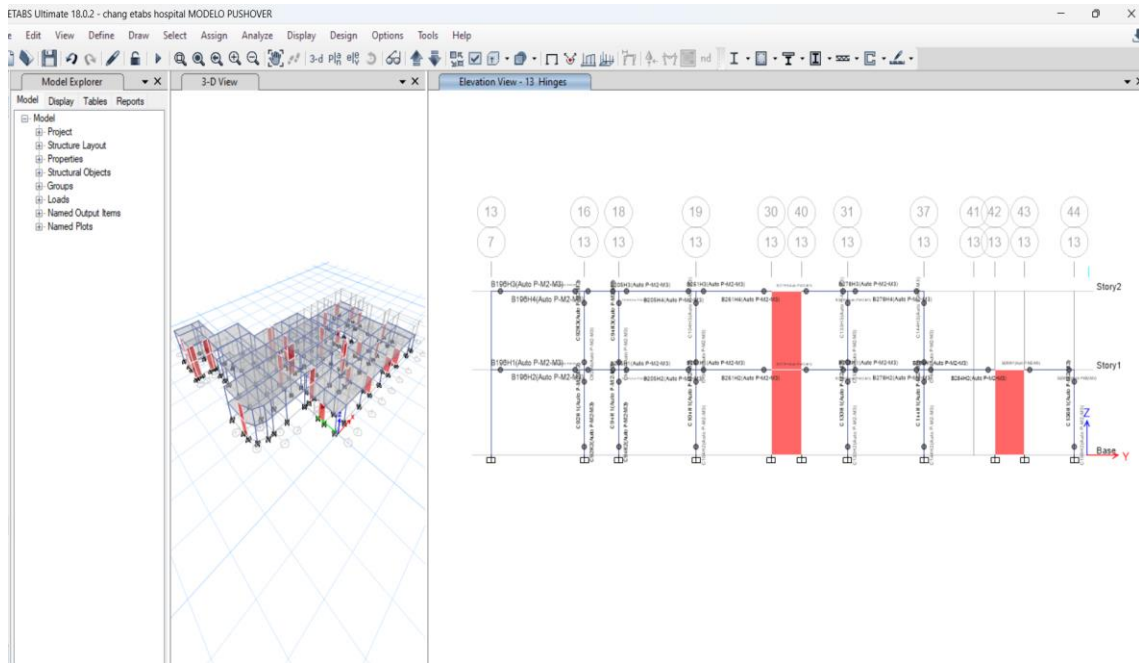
Asignación de las rotulas plásticas en la estructura en vigas y columnas
